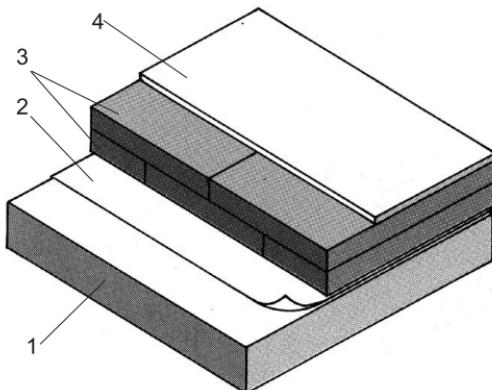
Теплоизоляция межэтажных перекрытий верхних этажей и чердачных перекрытий: 1 — железобетонная плита; 2 — гидроизоляция; 3 — теплоизолирующие плиты или маты; 4 — напольное плитное покрытие
